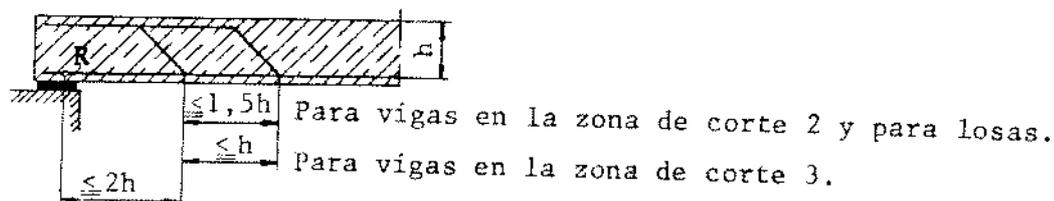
Separación admisible entre barras longitudinales dobladas que sirven para armadura de corte.
